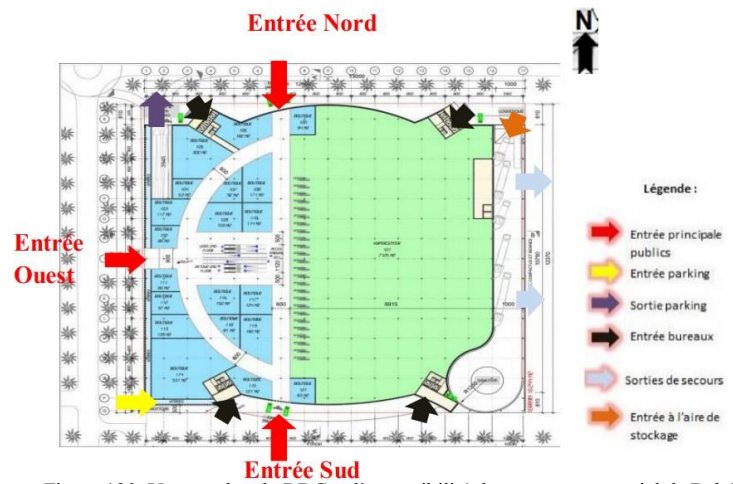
Vue en plan du RDC et l'accessibilité du centre commercial de Bab Ezzouar.
